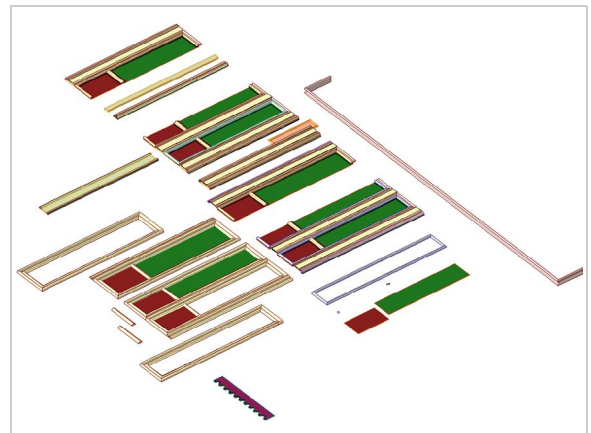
Wandauflagen des Betsaals im Erdgeschoß beim Erstellen der jeweiligen Bibliotheksobjekte im Grundriss.
